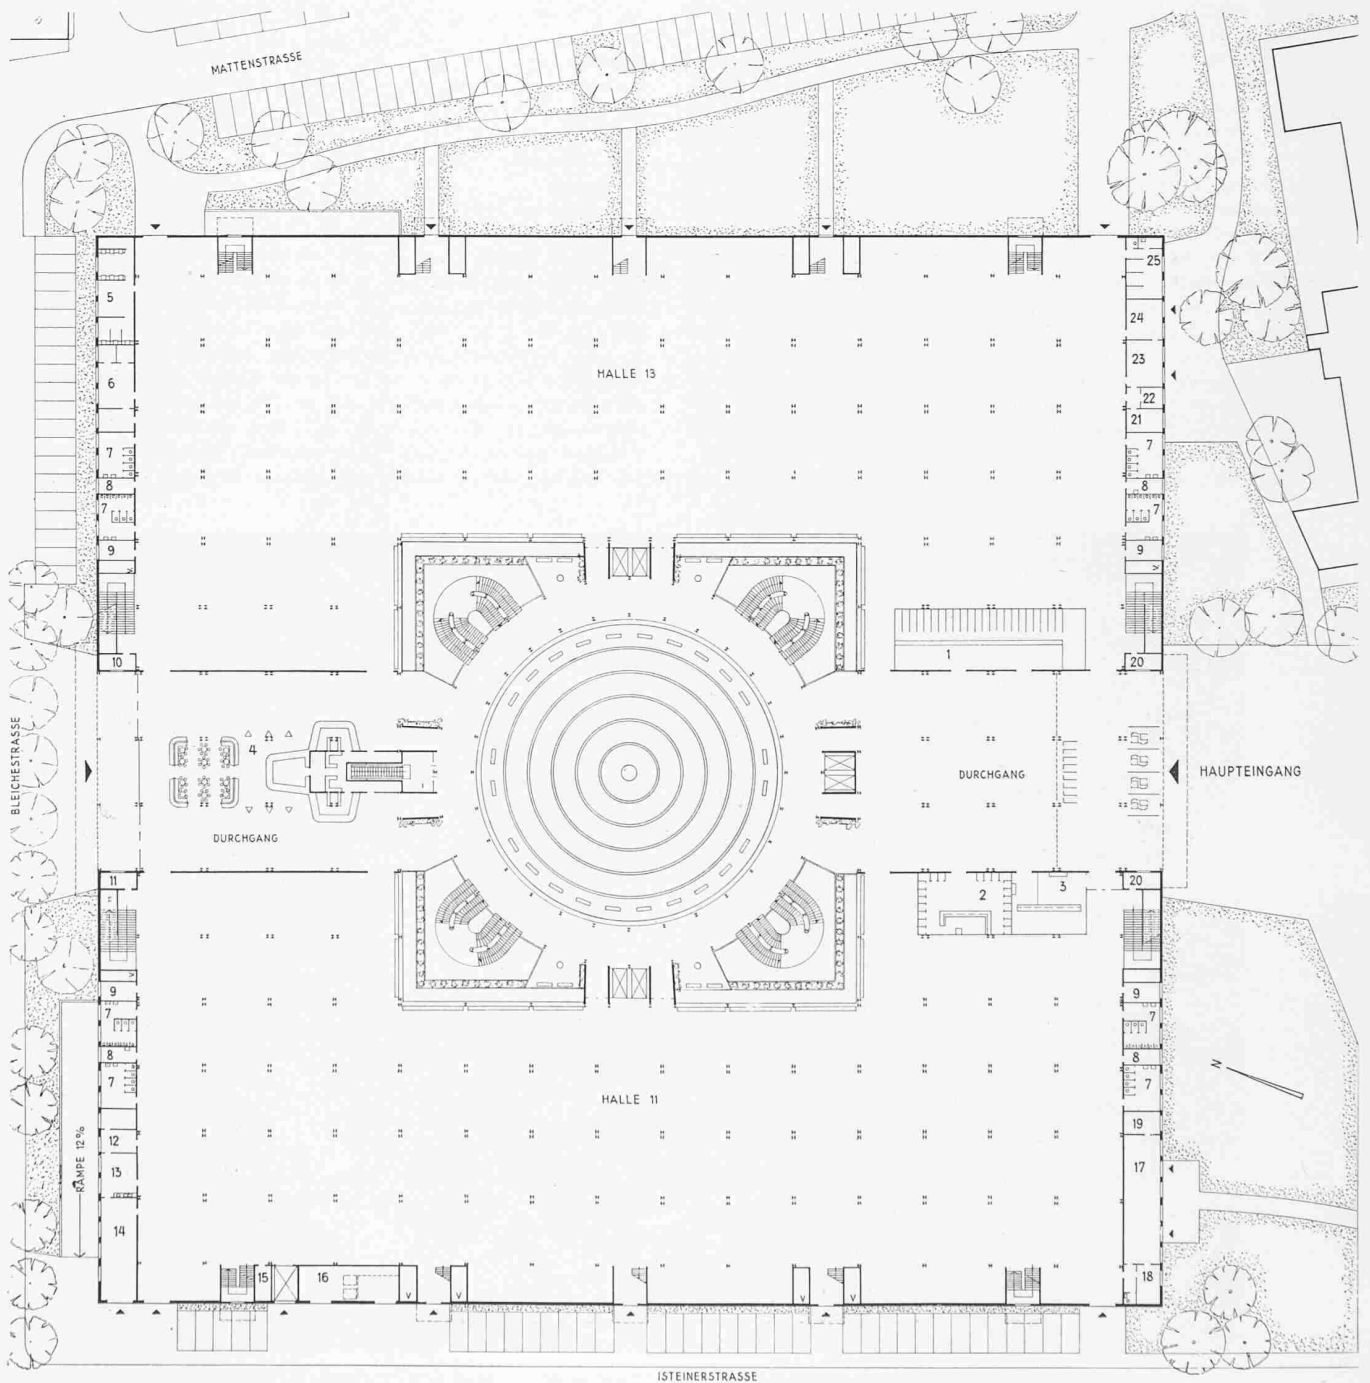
Erdgeschossgrundriss, Masstab 1:1000. — Der Neubau trägt die offizielle Bezeichnung «Hallen 10 bis 21»
